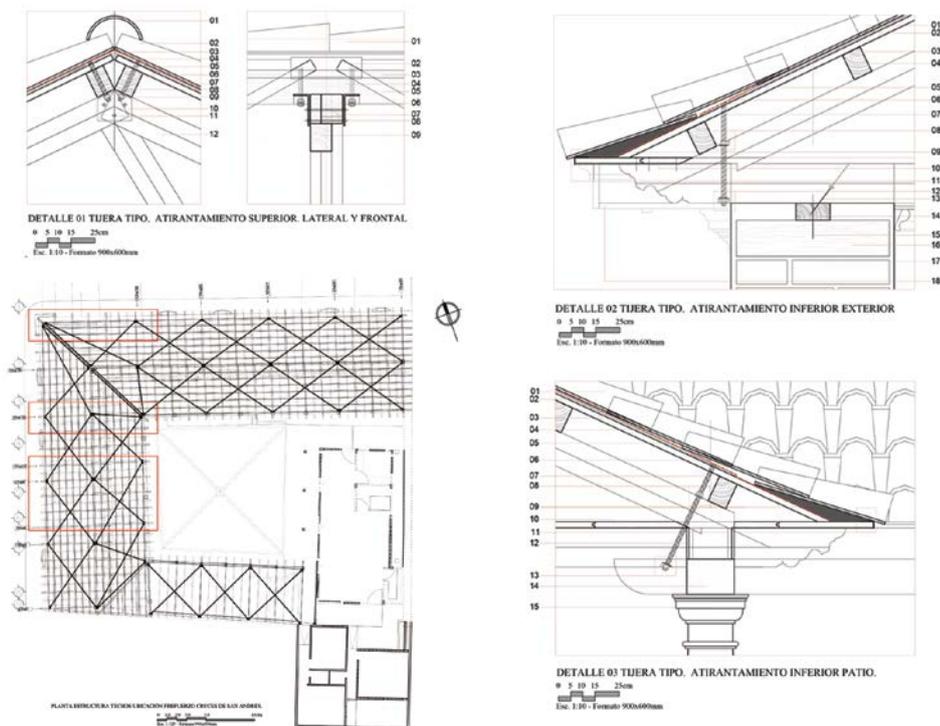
Nivel estructural. Refuerzo de techos con sistema de cruces de San Andrés ancladas a la estructura principal de madera.
